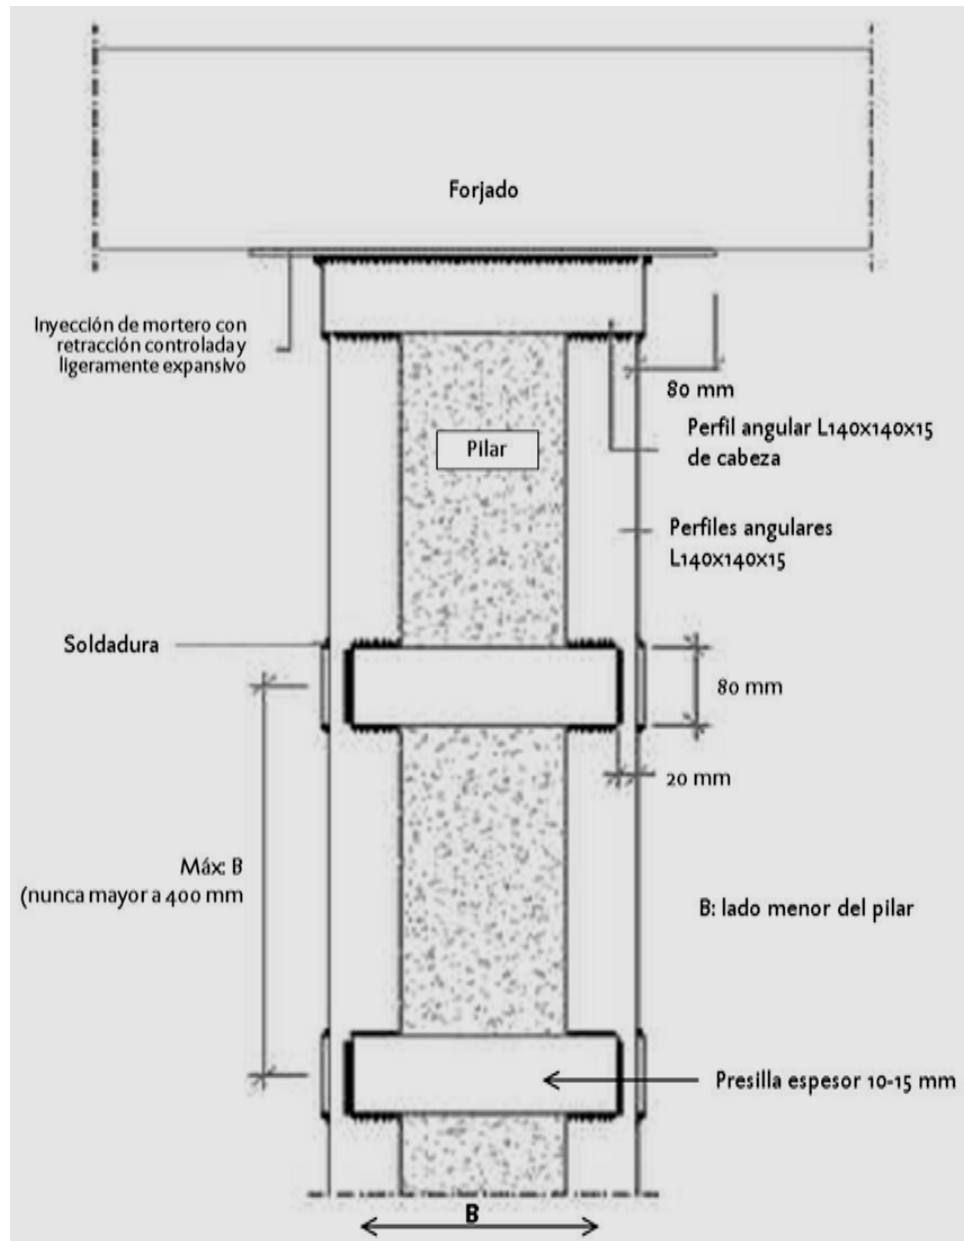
Refuerzo de pilares apantallados con un empresillado metálico
